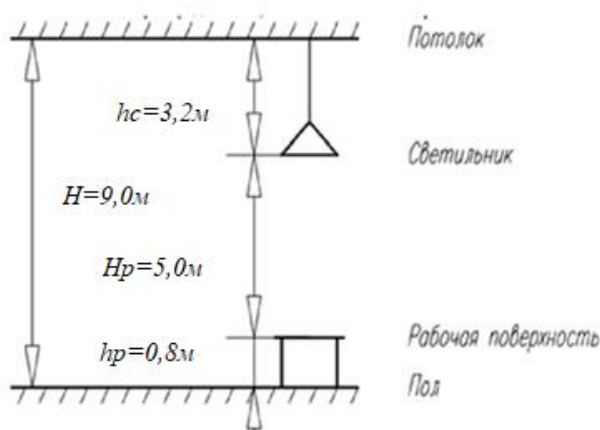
Схема размещения светильников по высоте помещения литейного цеха
